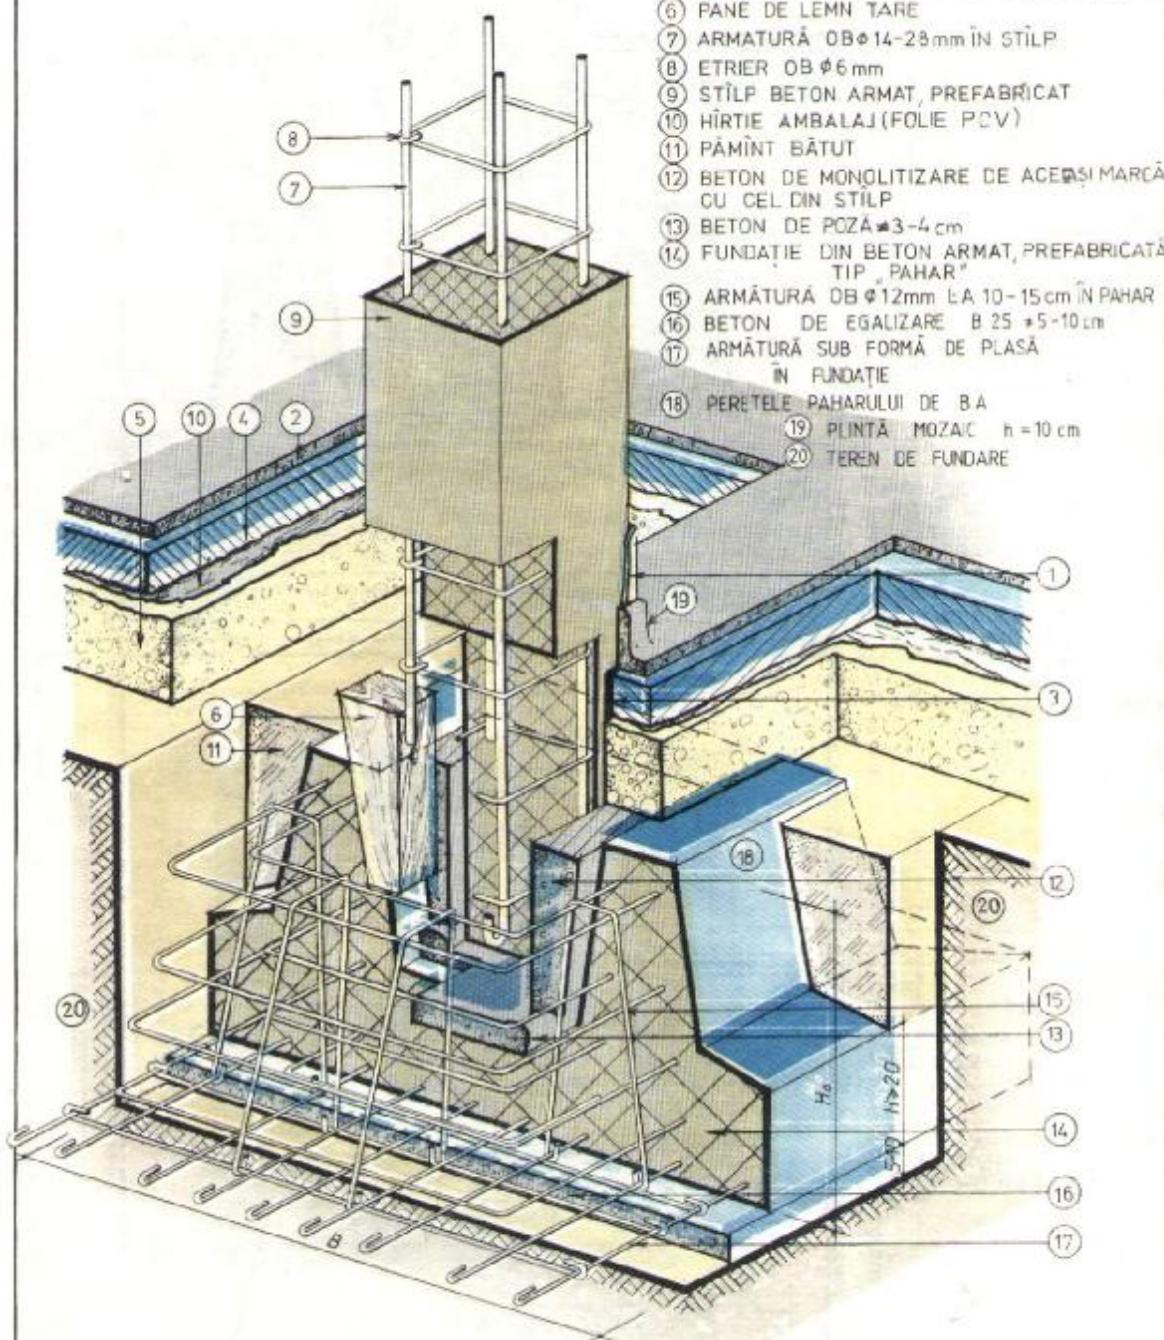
Fundație-pahar, prefabricată din beton armat, pentru stilpi prefabricați din beton armat:
